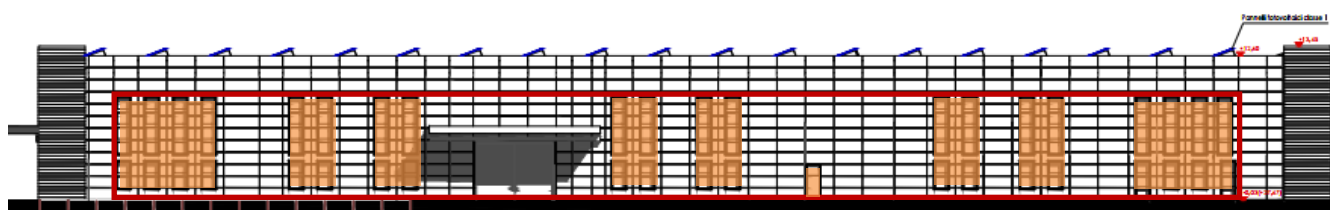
prospetto est con evidenza delle superfici radianti e del perimetro della piastra radiante (tratteggio rosso)
